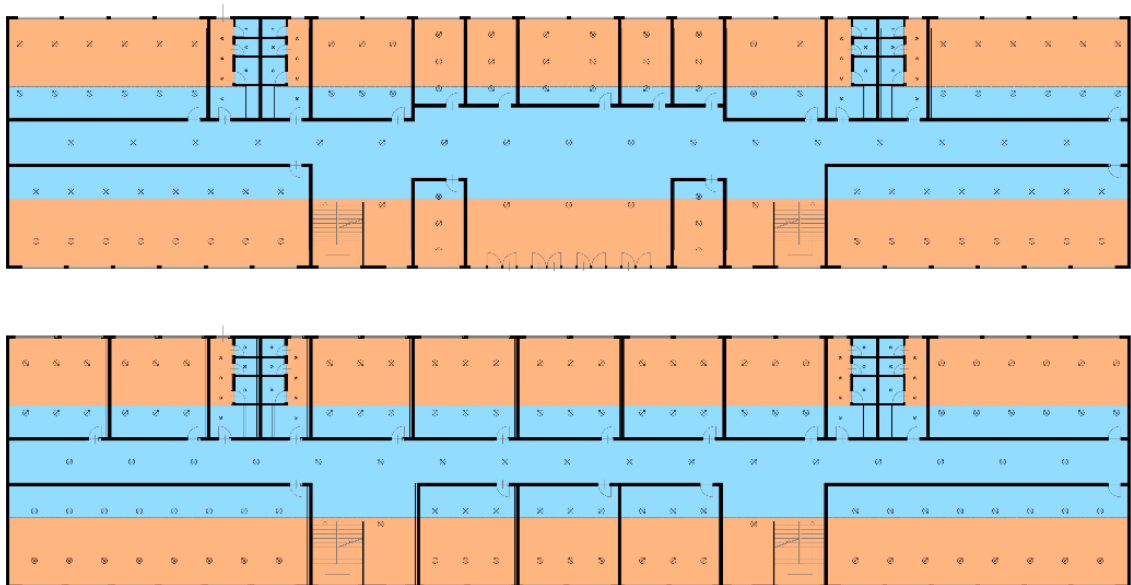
Planimetria del piano terra e del piano tipo con indicazione, per ciascun locale, delle aree A_D (arancio) e A_{ND} (azzurro) e posizionamento degli apparecchi.
